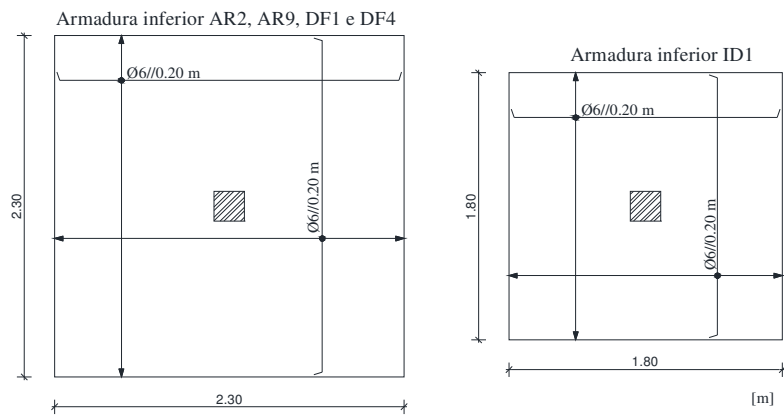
Armaduras longitudinais inferiores dos modelos.
